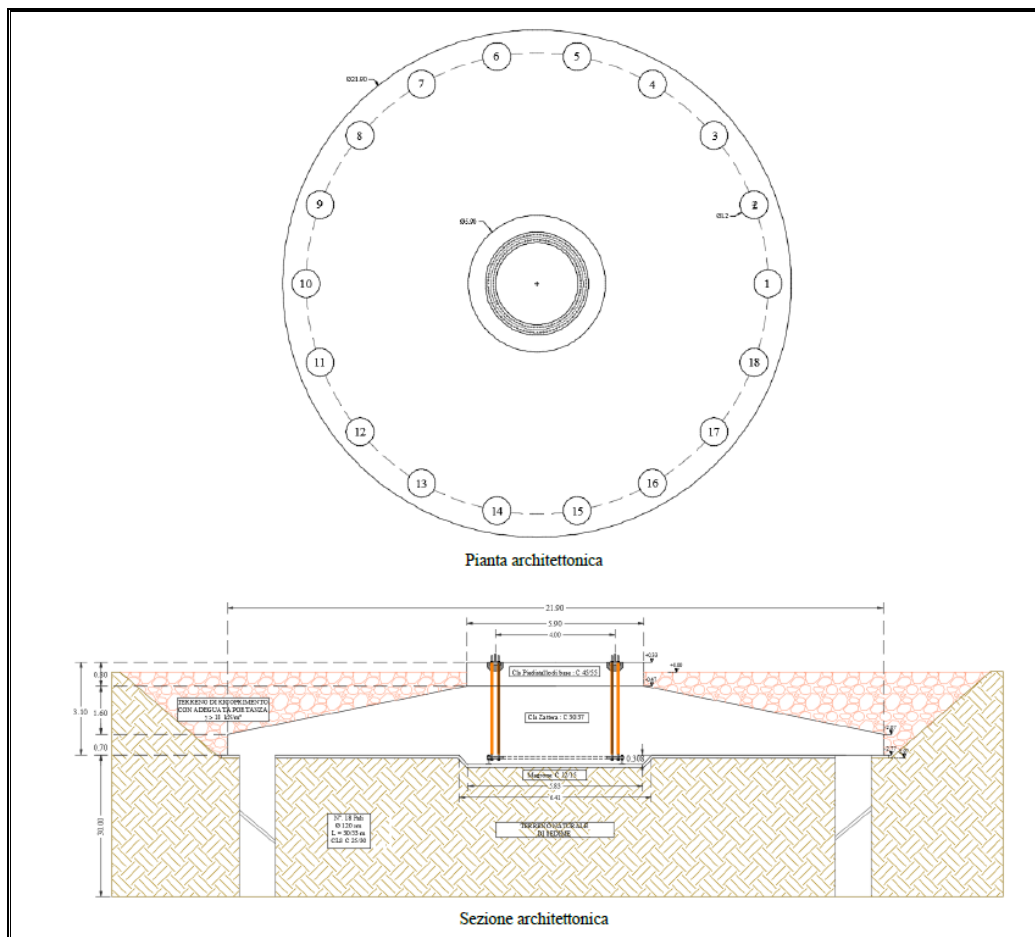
Sezione e Pianta architettonica tipo della fondazione.
